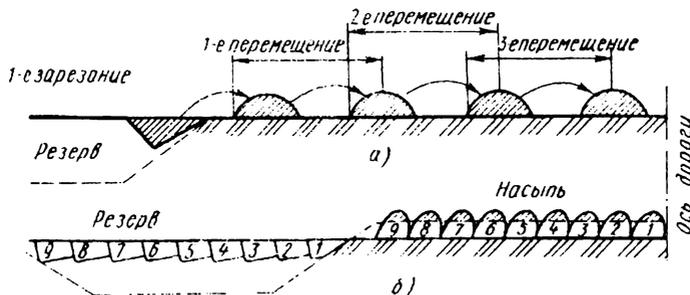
Разработка резерва; а – резание и перемещение грунта; б – укладка грунта; 1...9 – проходы автогрейдера.
